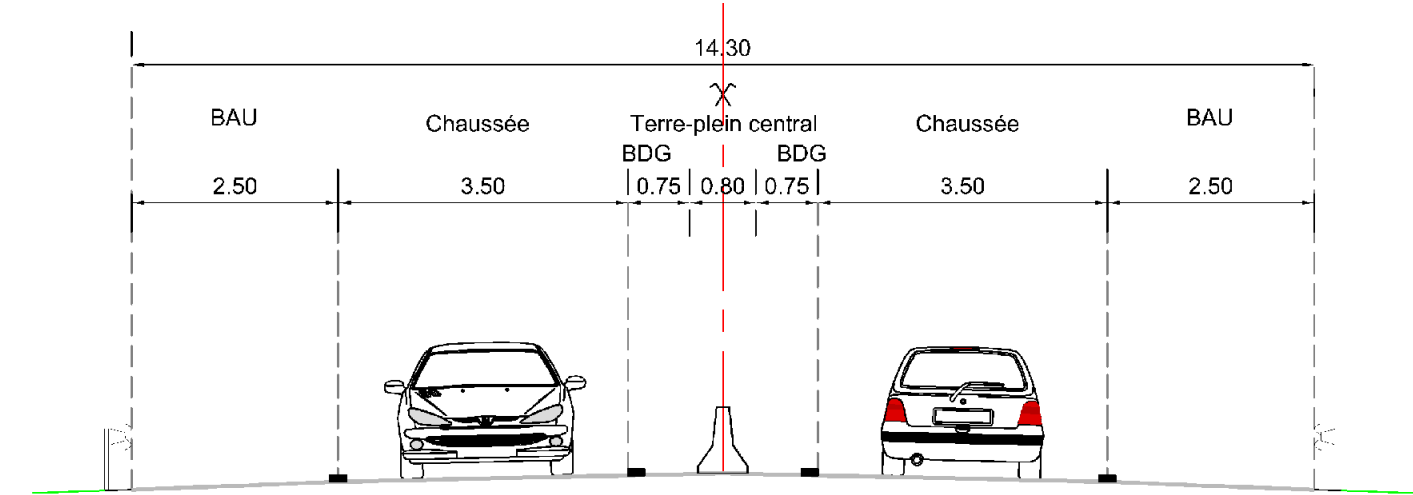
Profil en travers pour route à 2x1 voie à chaussées séparées en section courante
